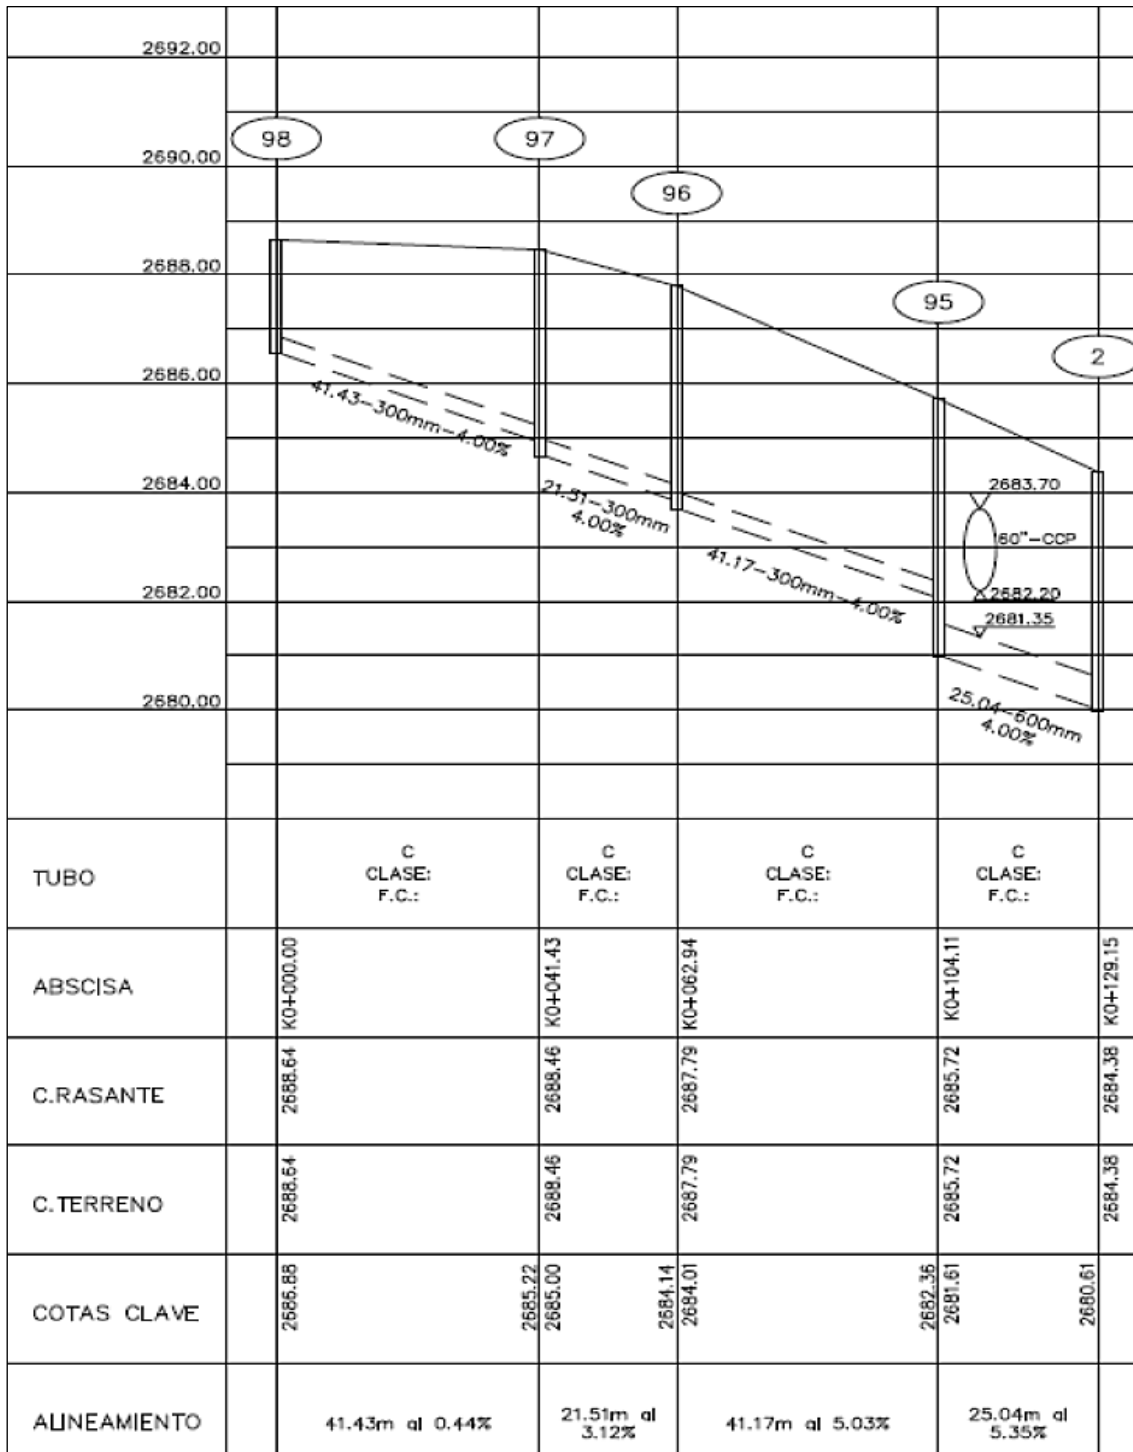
Perfil del tramo de alcantarillado propuesto para la conexión del Pozo 95 con el Pozo 2, a instalar mediante tecnología sin zanja. Tomado de: (Rodríguez Gutierrez, Molano Garay, & Vargas Manrique, 2016)
